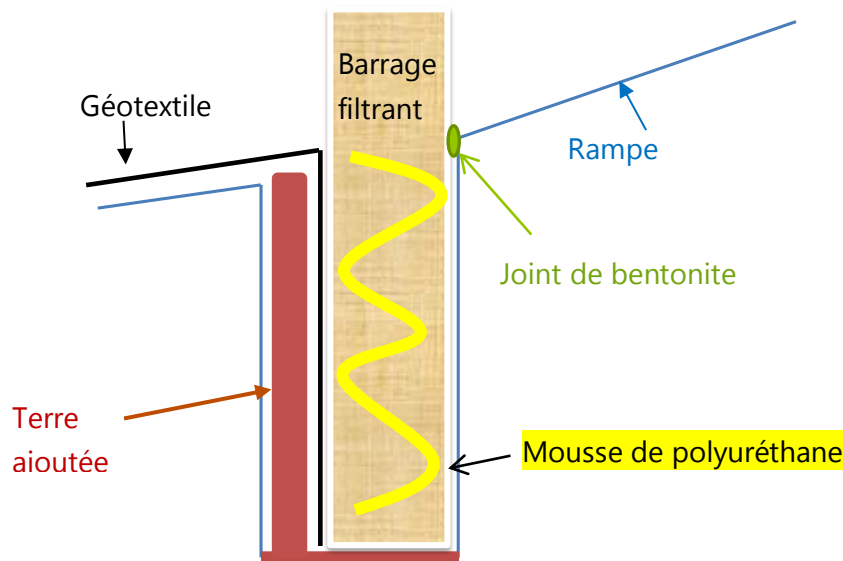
Coupe transversale schématique de l'enchâssement du barrage filtrant
